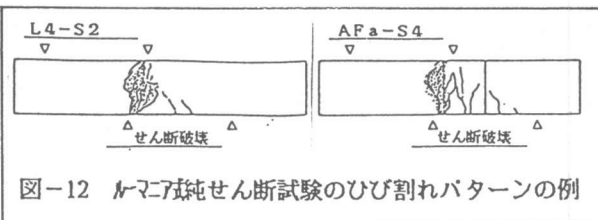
ルーミア純せん断試験のひび割れパターンの例
